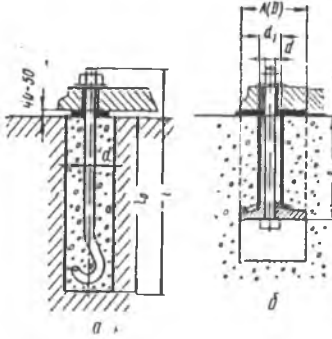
К расчету длины фундамента болтов (а) и размеров анкерных плит (б)
